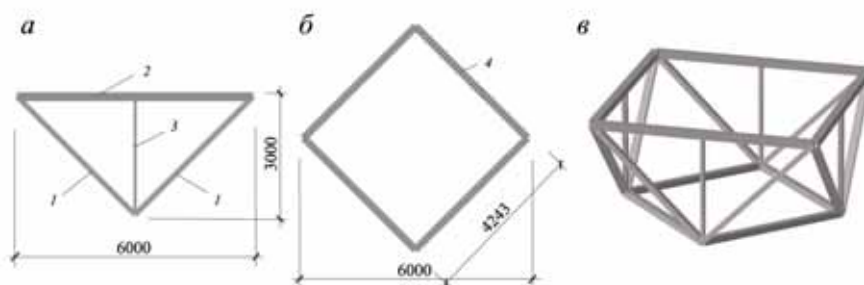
Сборные элементы структуры: а – треугольный элемент ТК (ТС); б – элемент нижнего пояса КК; в – ячейка структуры из элементов ТК (ТС) и КК. 1 – раскос; 2 – ригель верхнего пояса; 3 – стойка; 4 – ригель нижнего пояса
